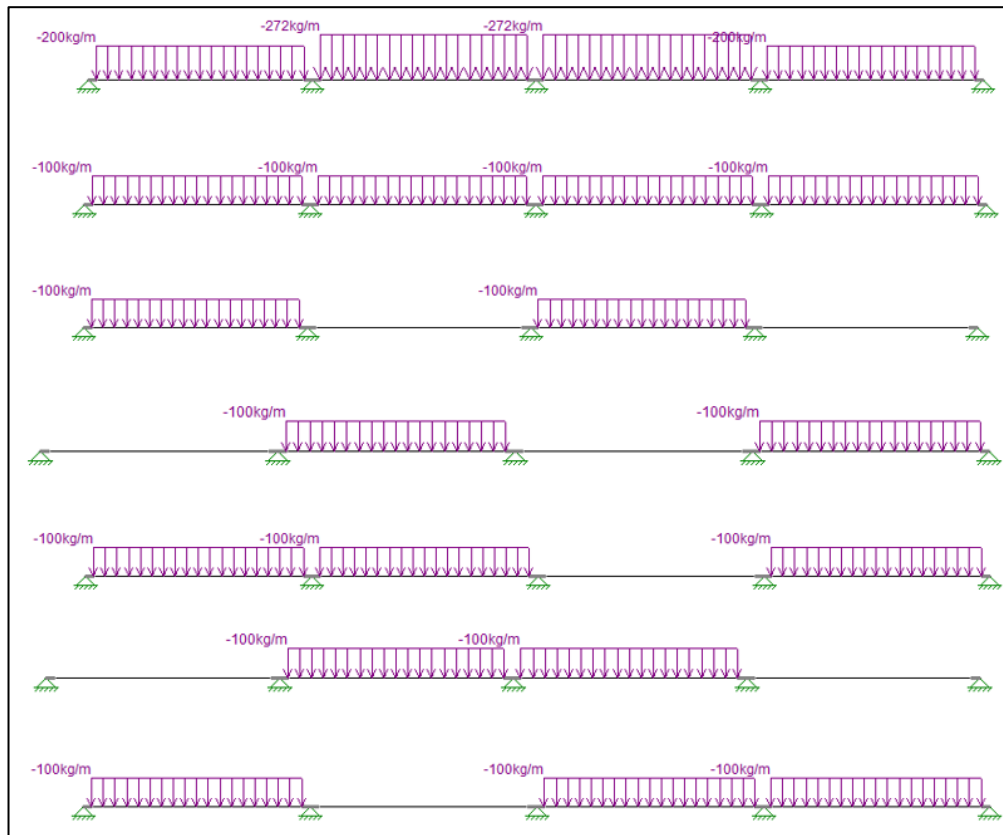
estados de cargas consideradas en el diseño de losas – primer techo
